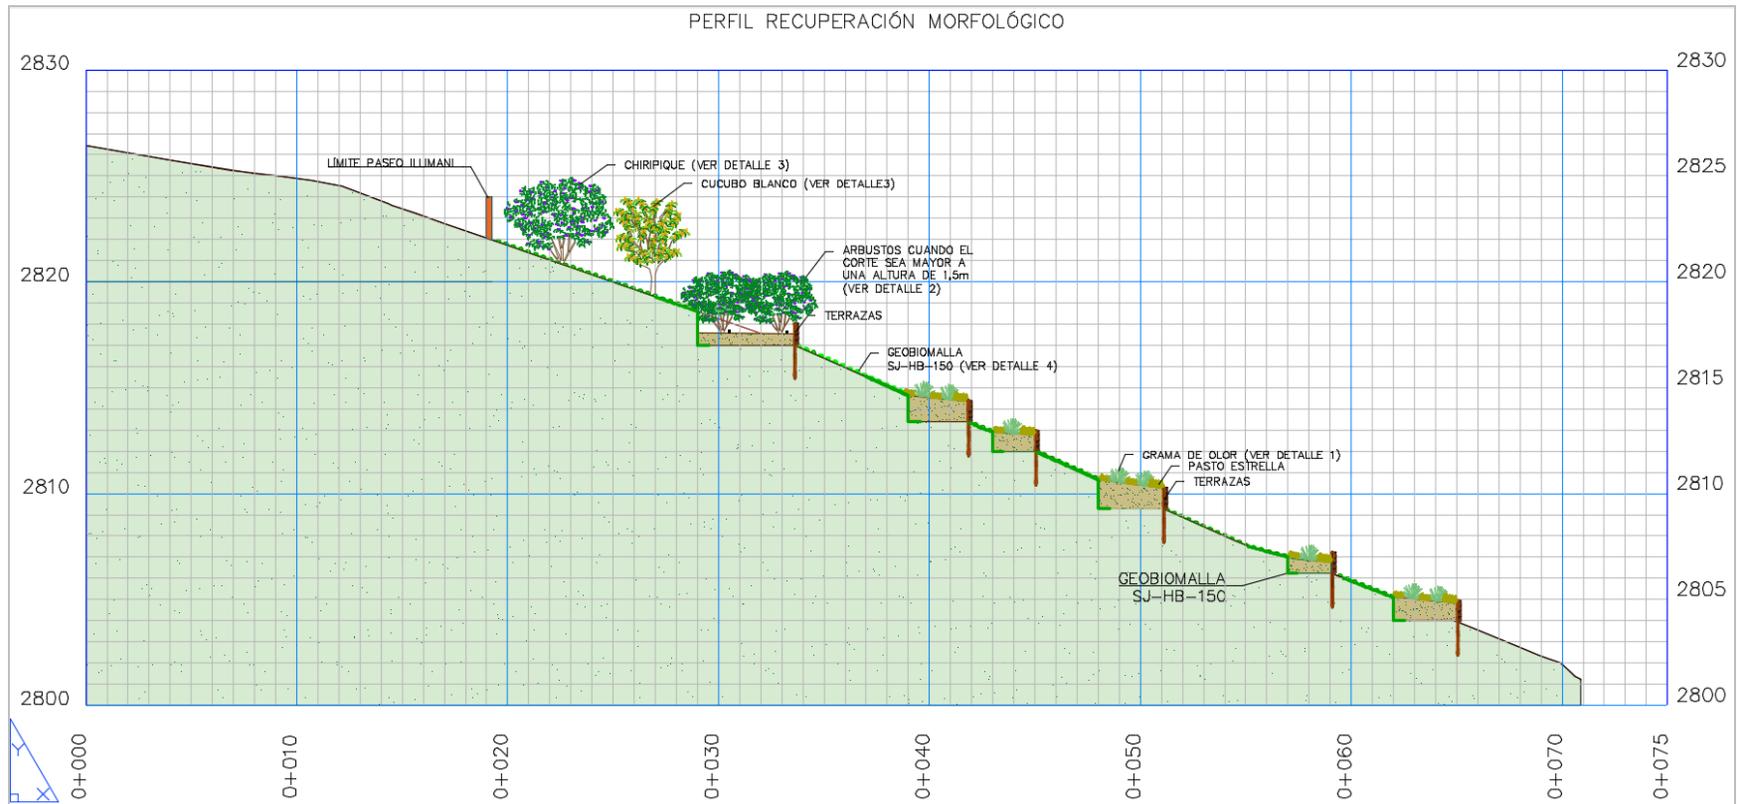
Propuesta de reconfiguración del terreno por medio de trinchos en madera (Anexo V8)
